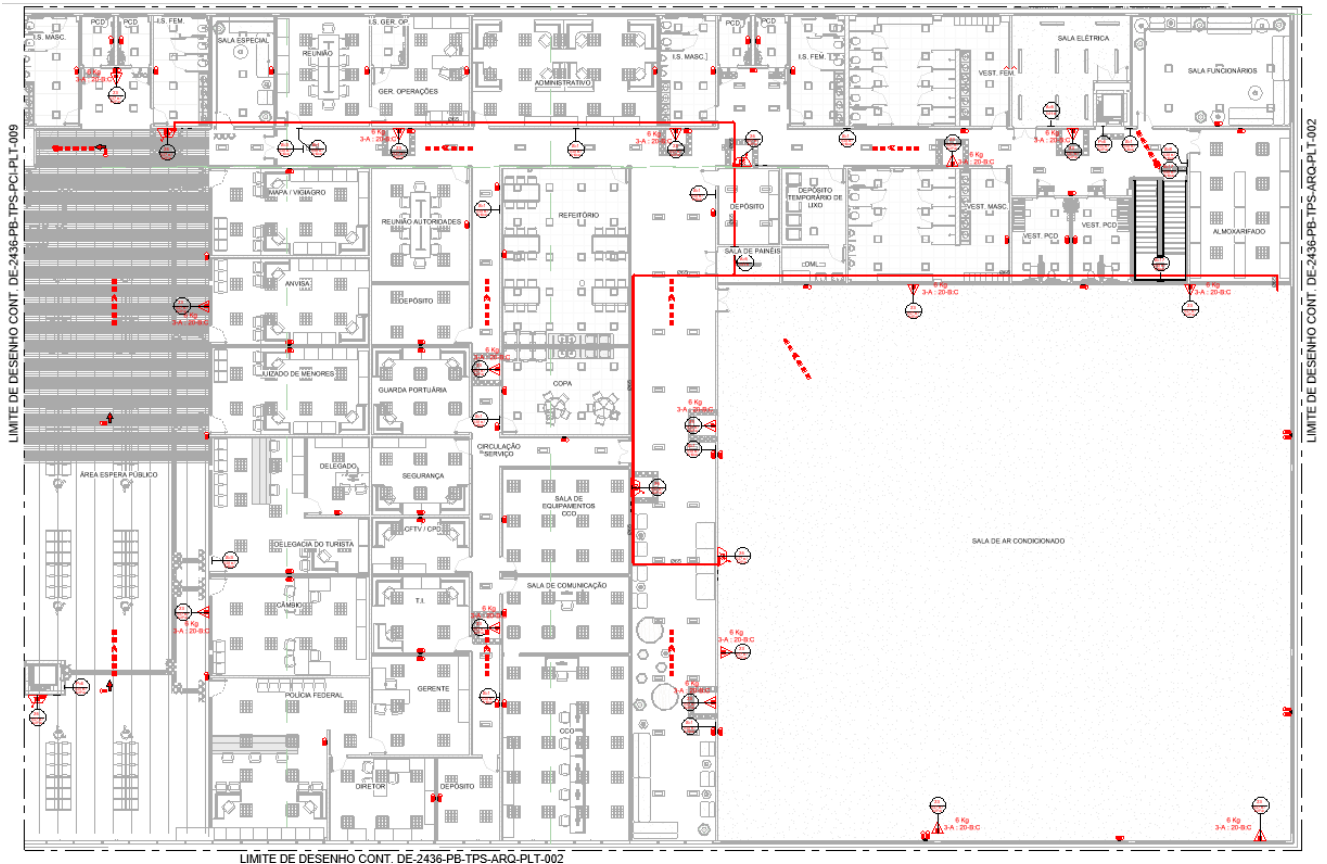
Arranjo dos hidrantes, extintores e sinalização no primeiro pavimento lado leste.
